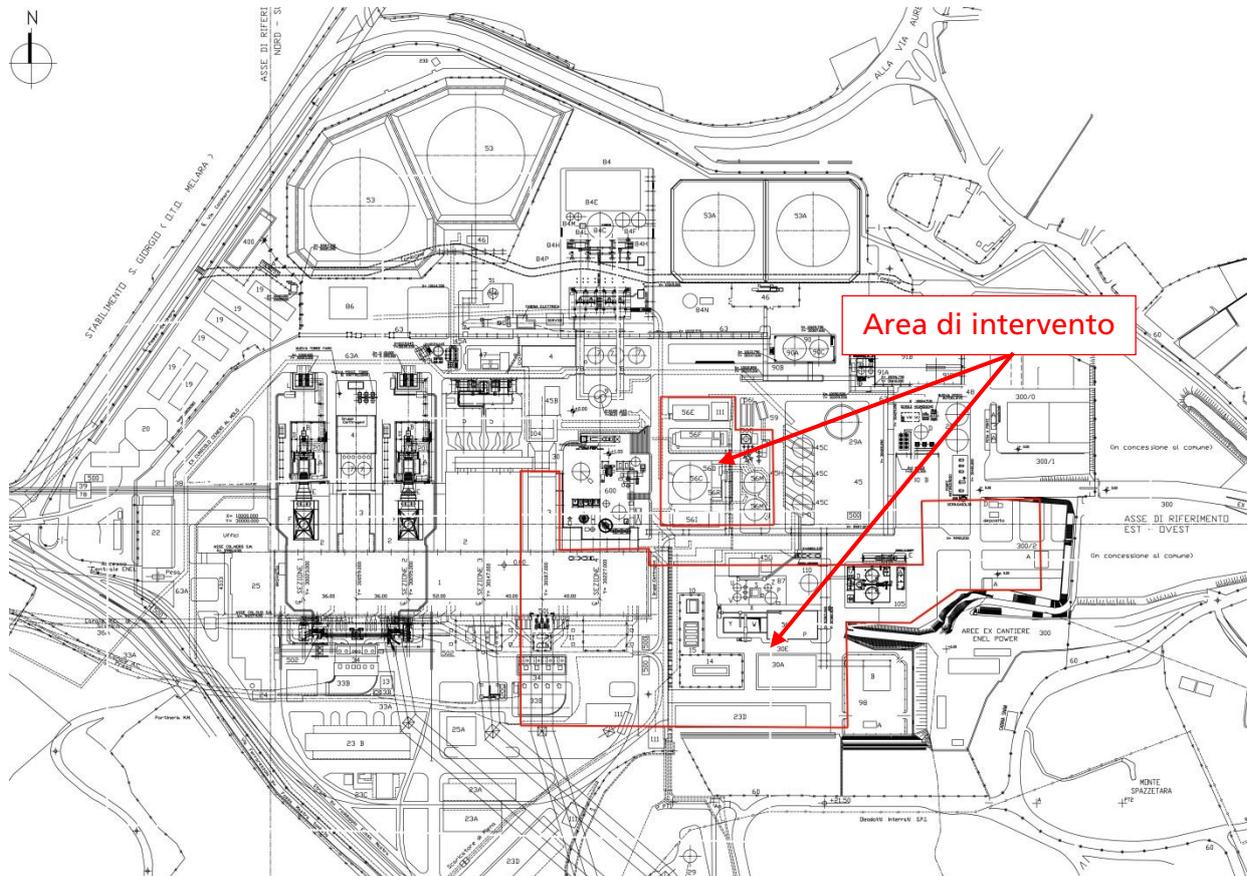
Planimetria dello stato attuale con indicata l'area di intervento
